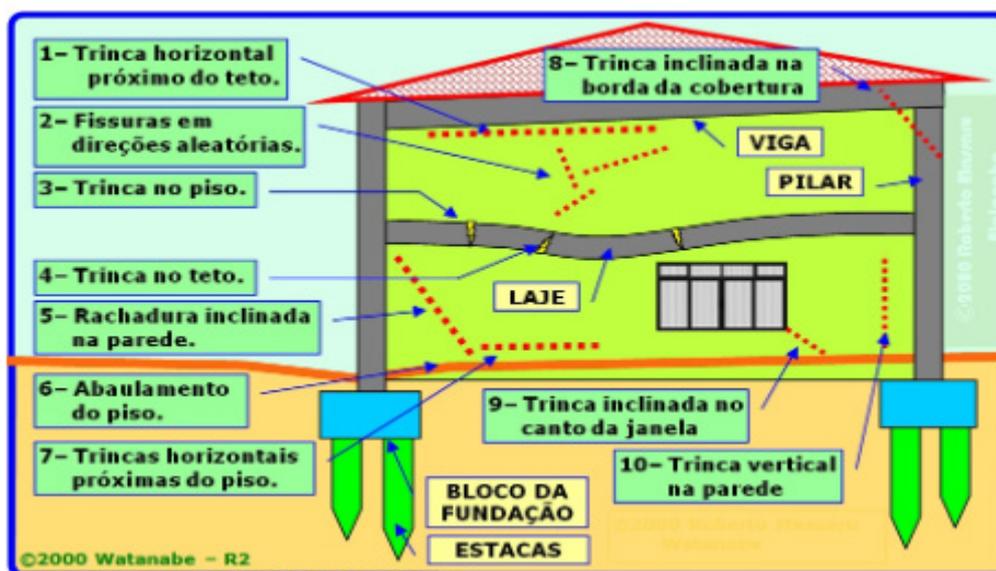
tipos de trincas, fissuras e rachaduras de acordo com a localização
